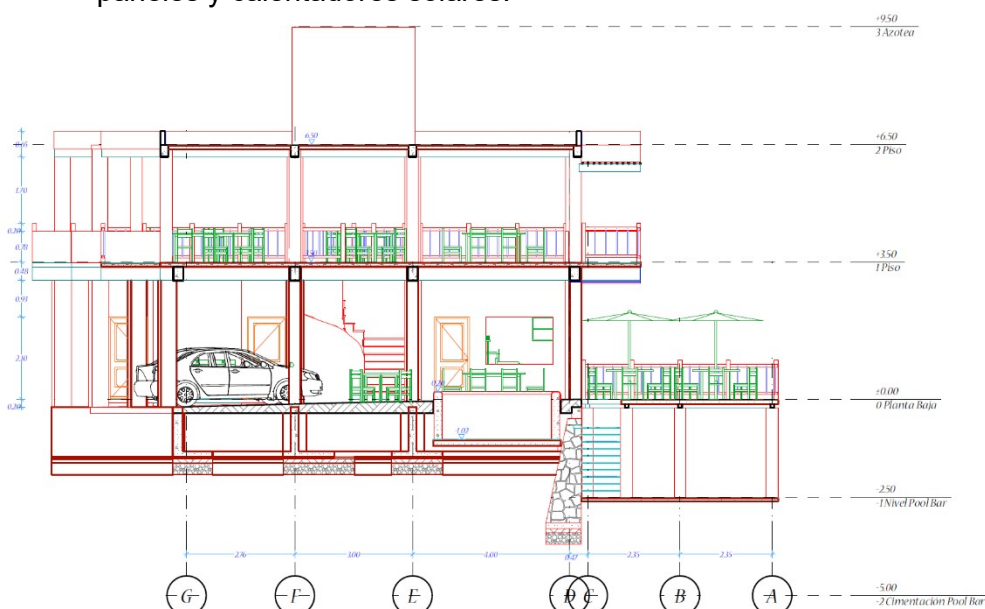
Corte longitudinal del proyecto de arquitectura de Restaurante Beso de Luna
